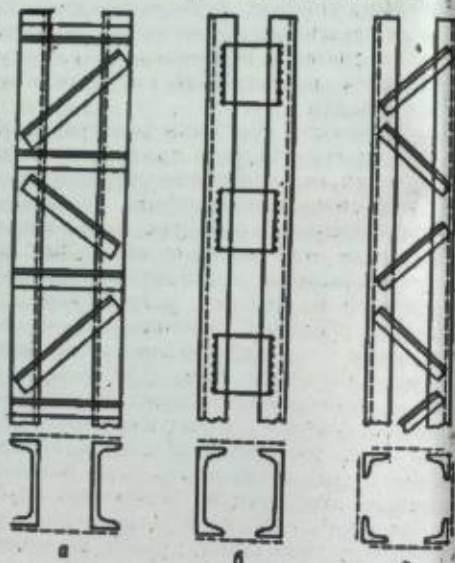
Решетчатые металлические колонны: а и в — с раскосами из уголков; б — безраскосные с соединением ветвей планками.
